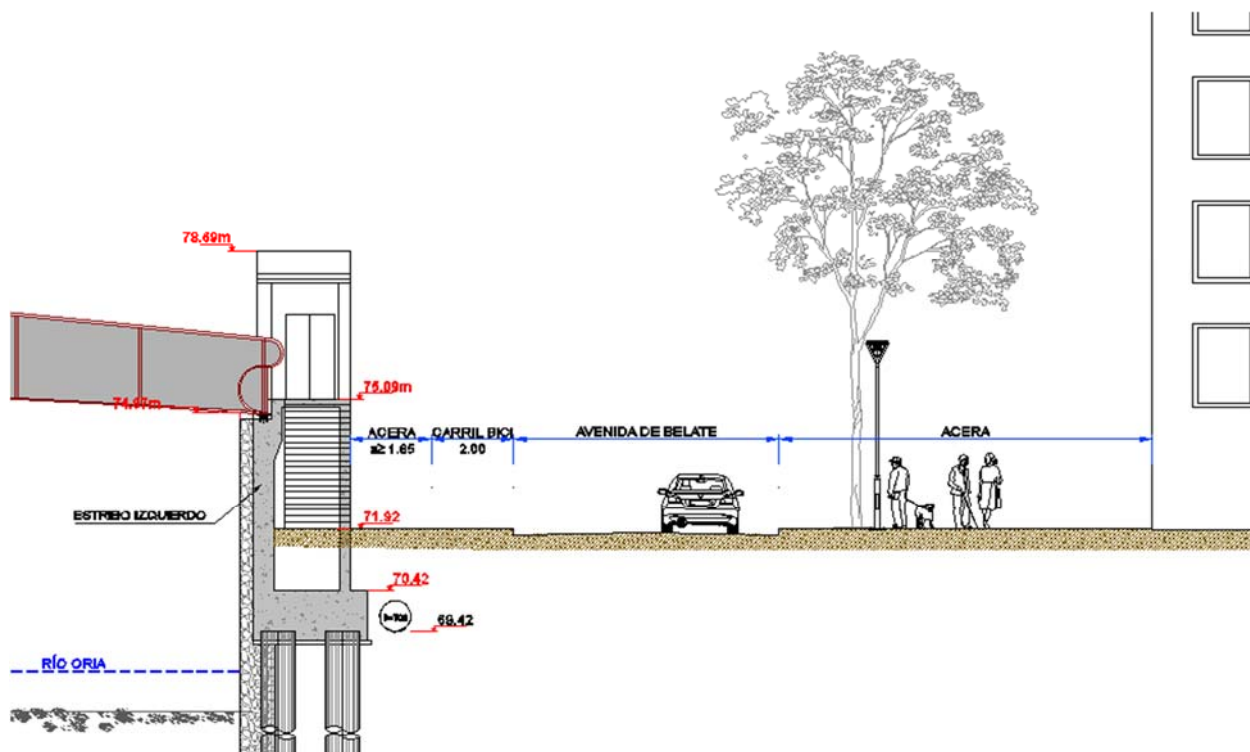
Detalle implantación urbana en el estribo izquierdo.
